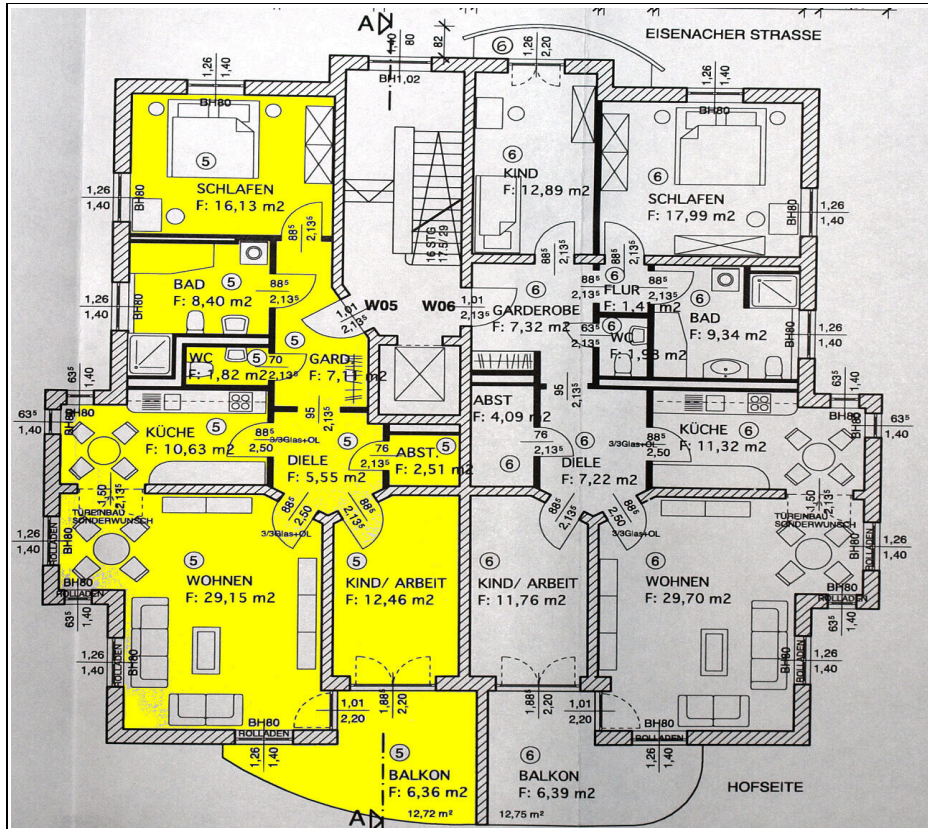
Grundriss des Wohnungseigentums Nr. 5 im 2. OG
